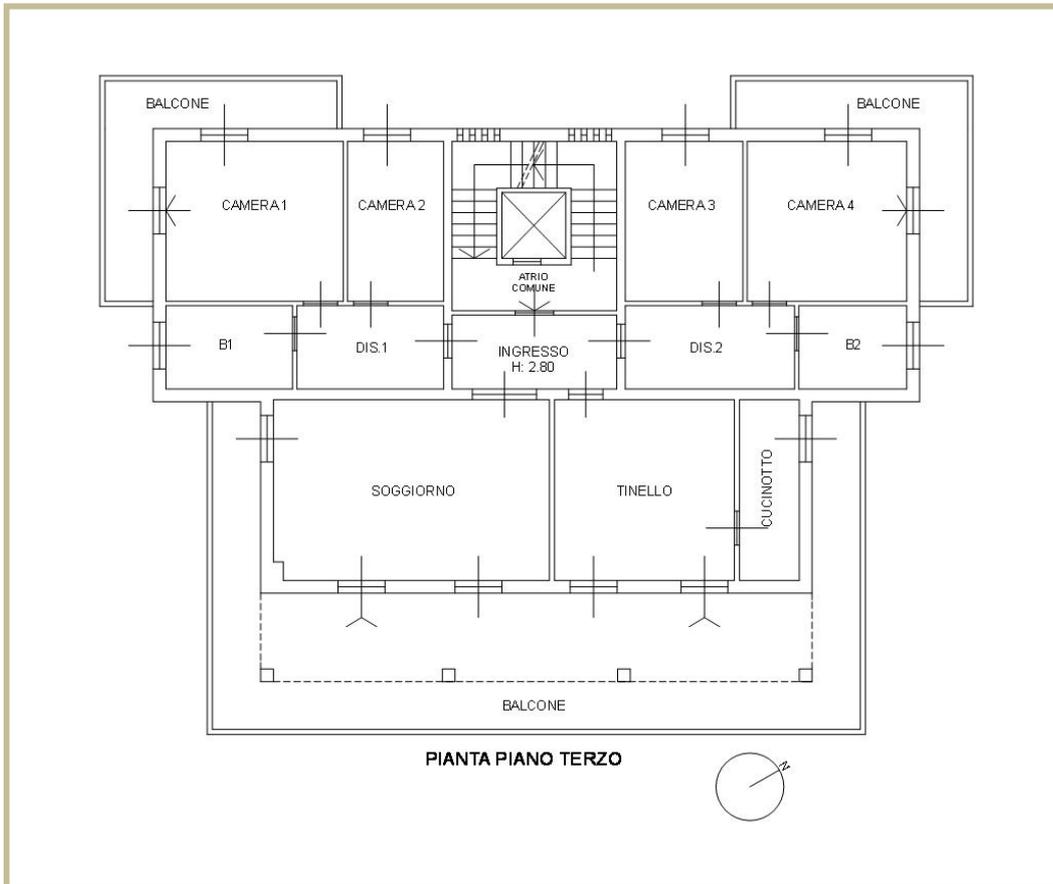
PIANTA P3 STATO DI FATTO REALIZZATO
